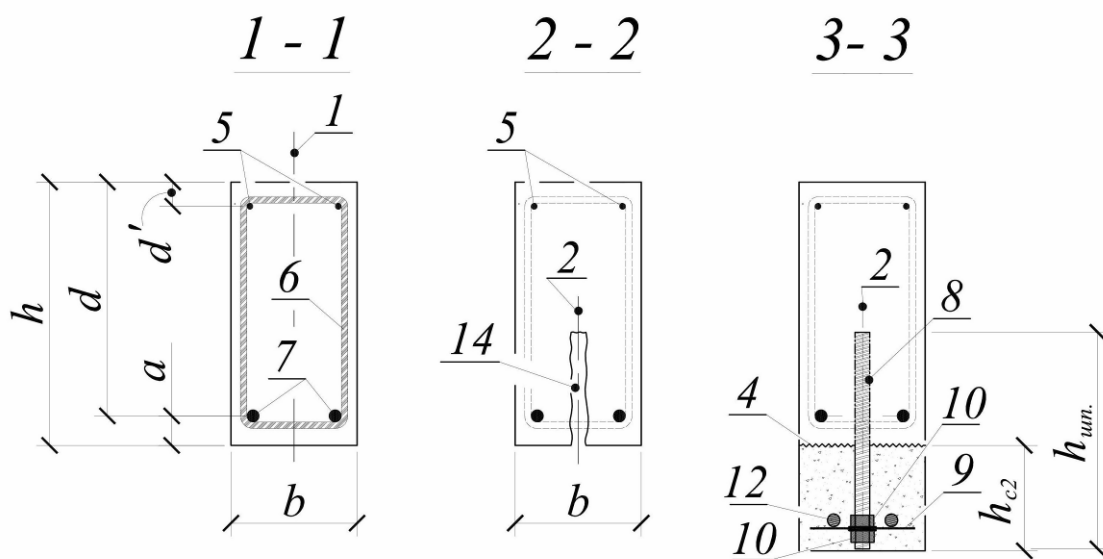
Поперечні перерізи посиленої балкової конструкції
